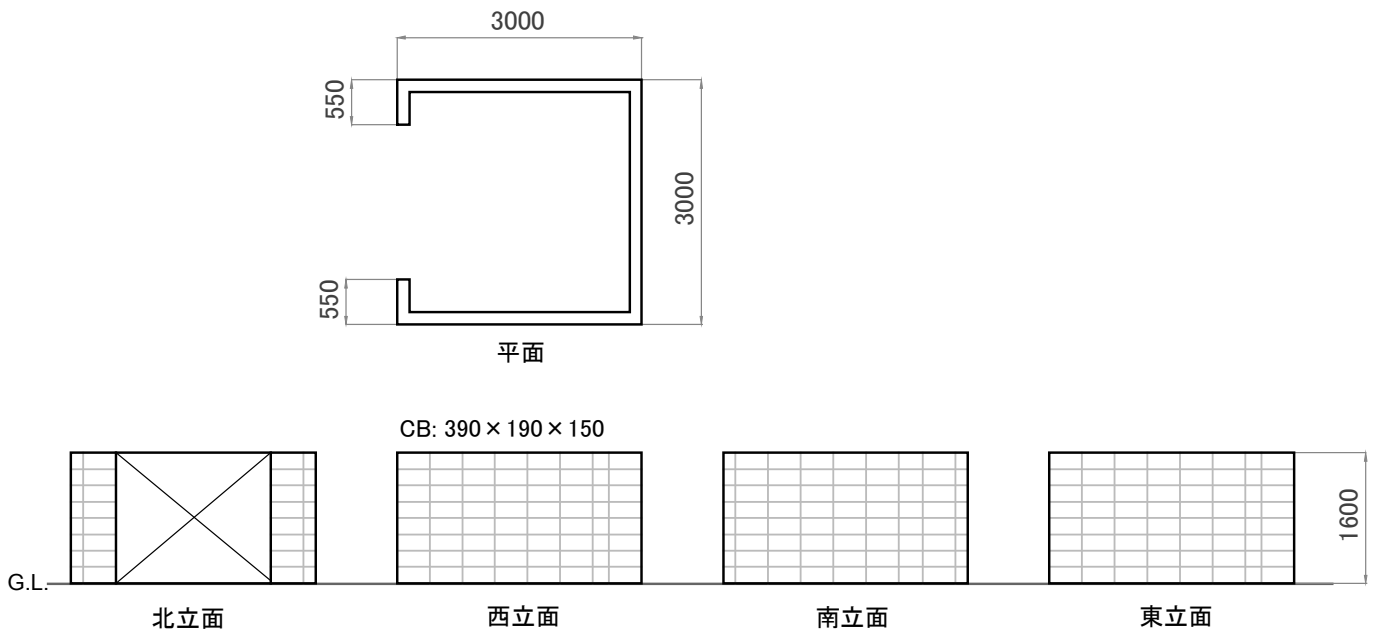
大豆センター脇の CB 塀 立面・平面図 (単位: mm)
